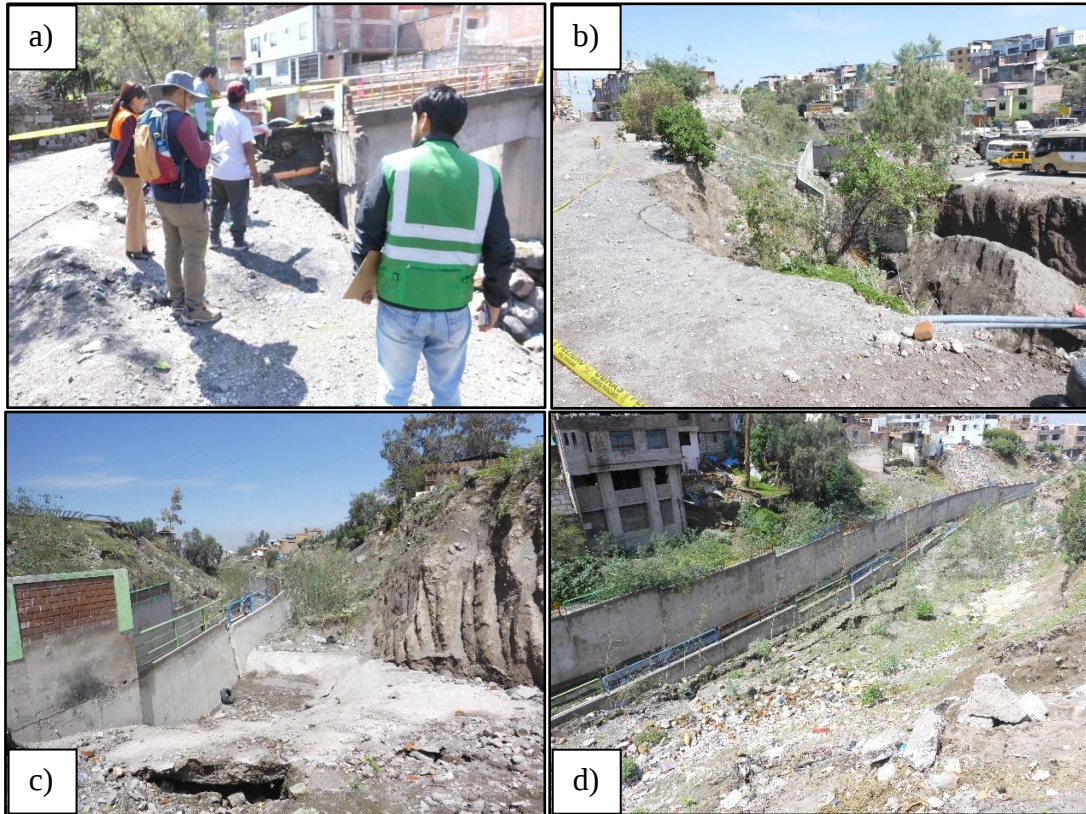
Quebrada Los Incas, parte baja, en el cual el pilar izquierdo del puente fue erosionado.
